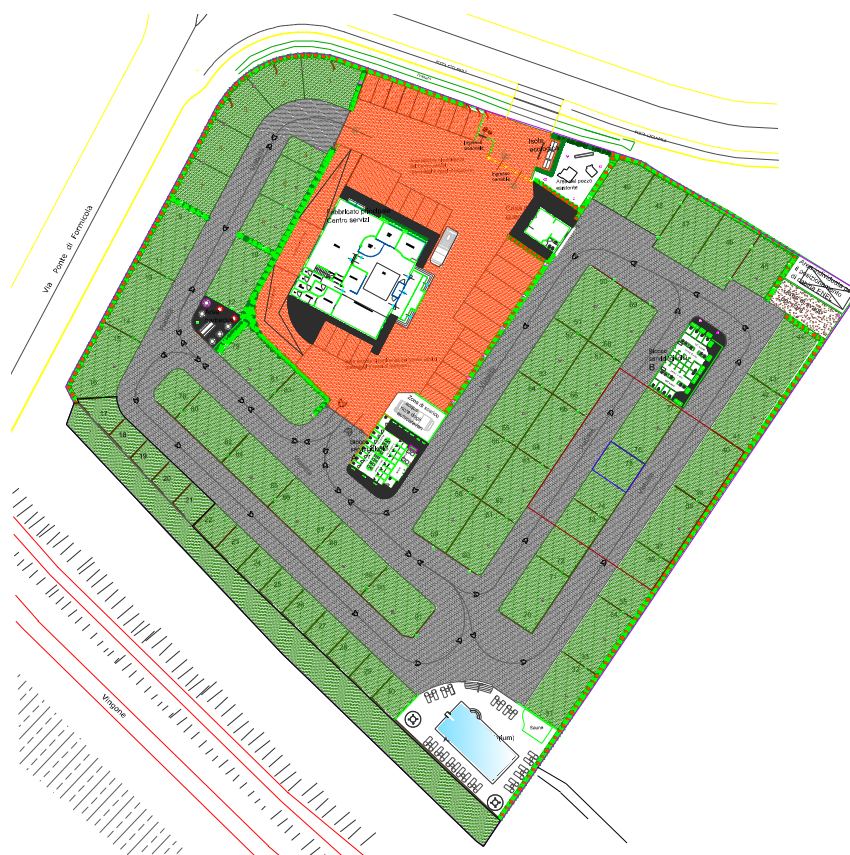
Planimetria dell'area di intervento allo stato di progetto
